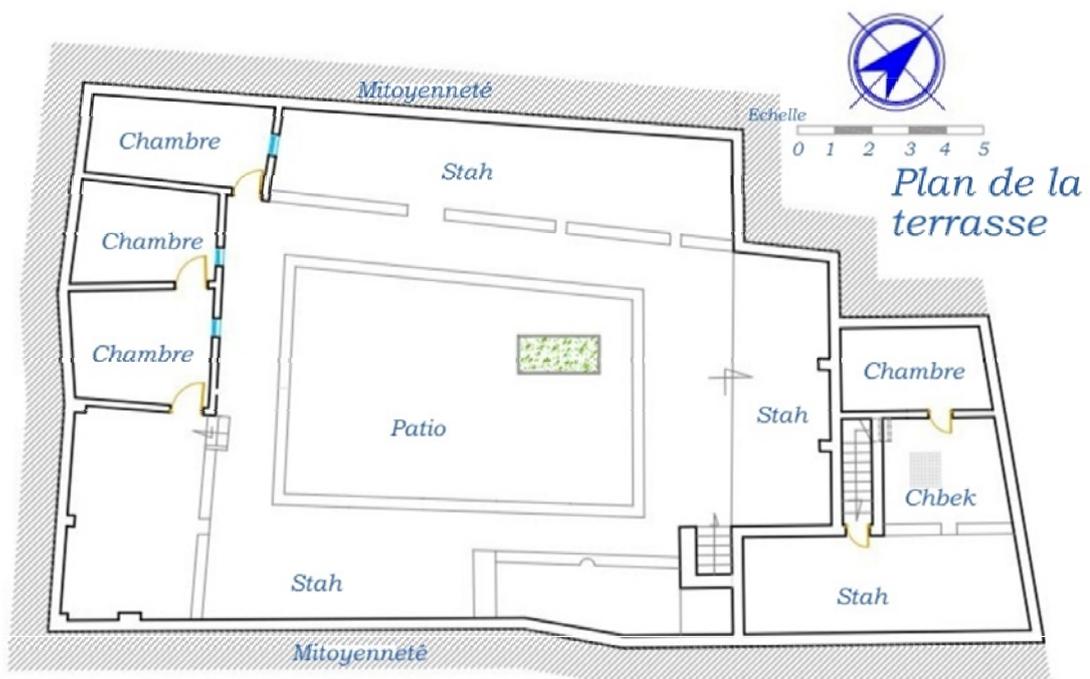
Plan de la terrasse. (Source S.Ammour, Architecte).
